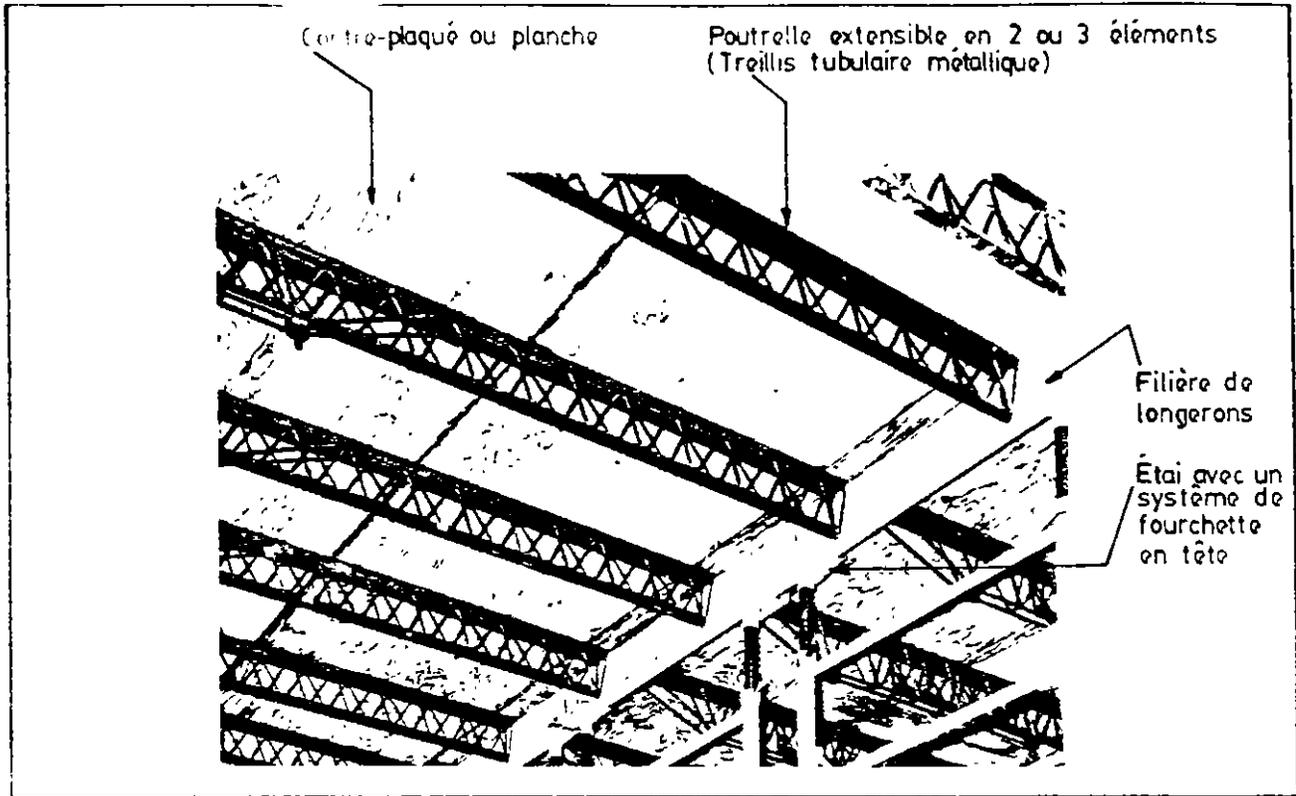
Poutrelles extensibles et platelage en contre-plaqué ou bois
